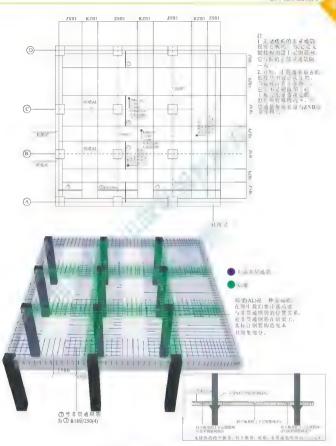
14 无梁楼板非贯通筋在结构施工医中的示意
